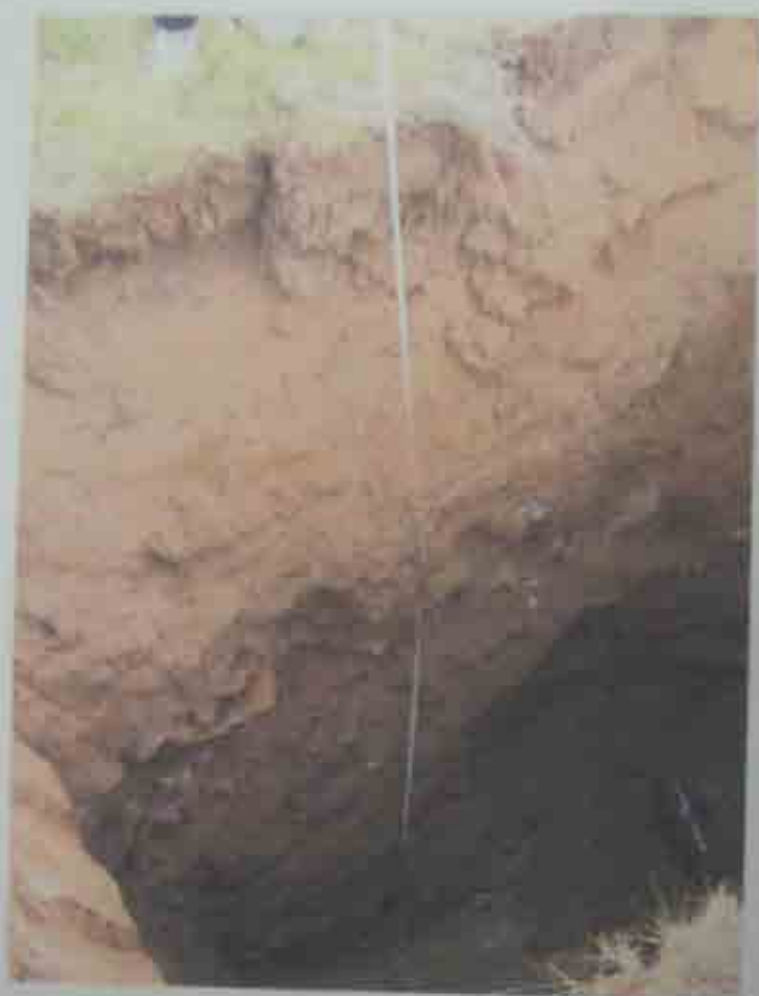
Sezione esposta del pozzetto esplorativo P1.
